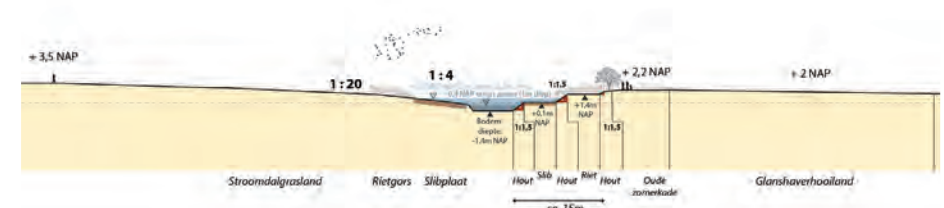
Doorsnede getrapte oever noordzijde.
